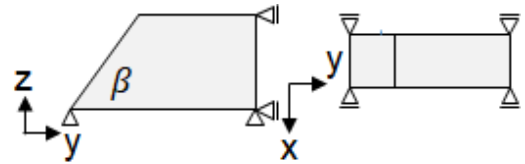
対象とする斜面と境界条件（左：断面図，右：平面図）
